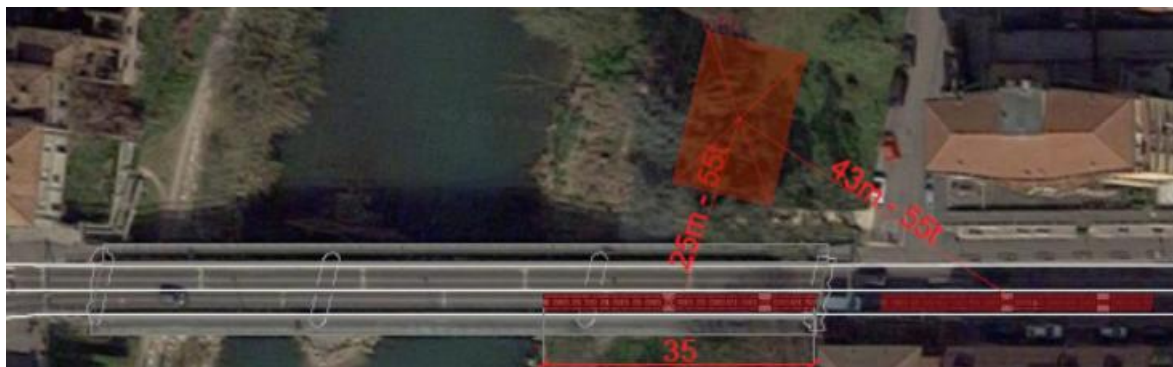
Varo campata lato San Bernardino – bitrave 1
